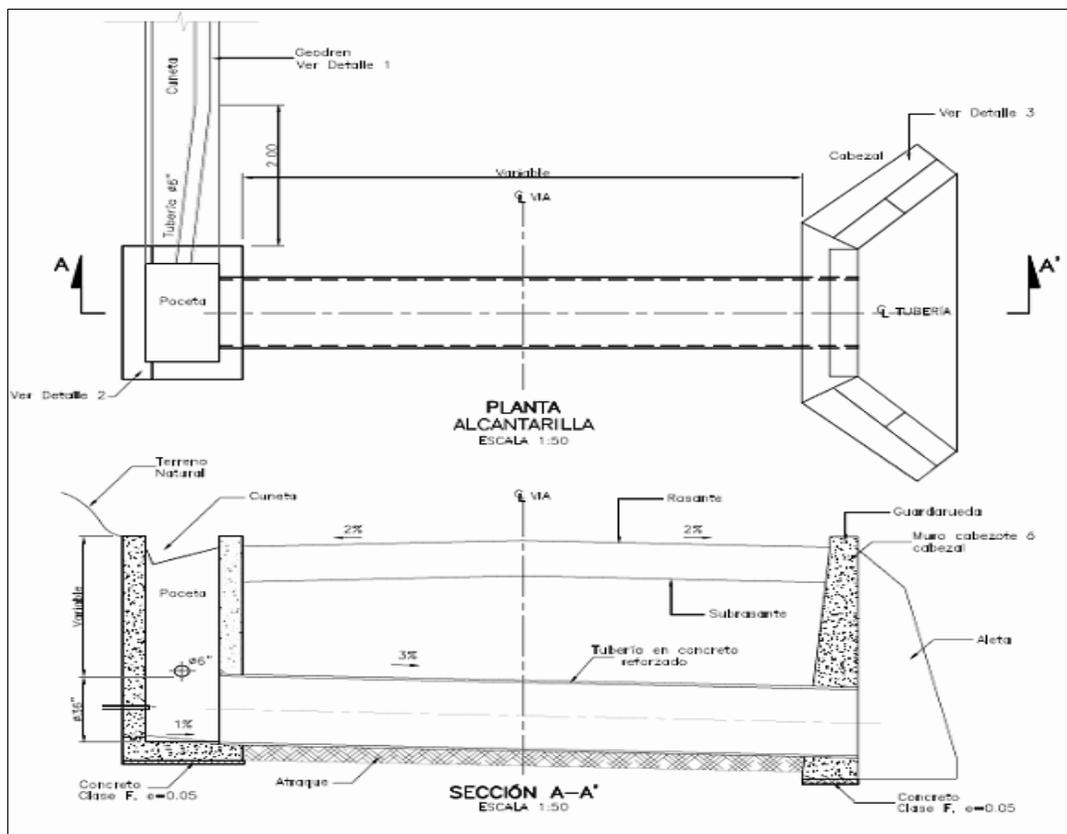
Diseño tipo de alcantarillas a utilizar
